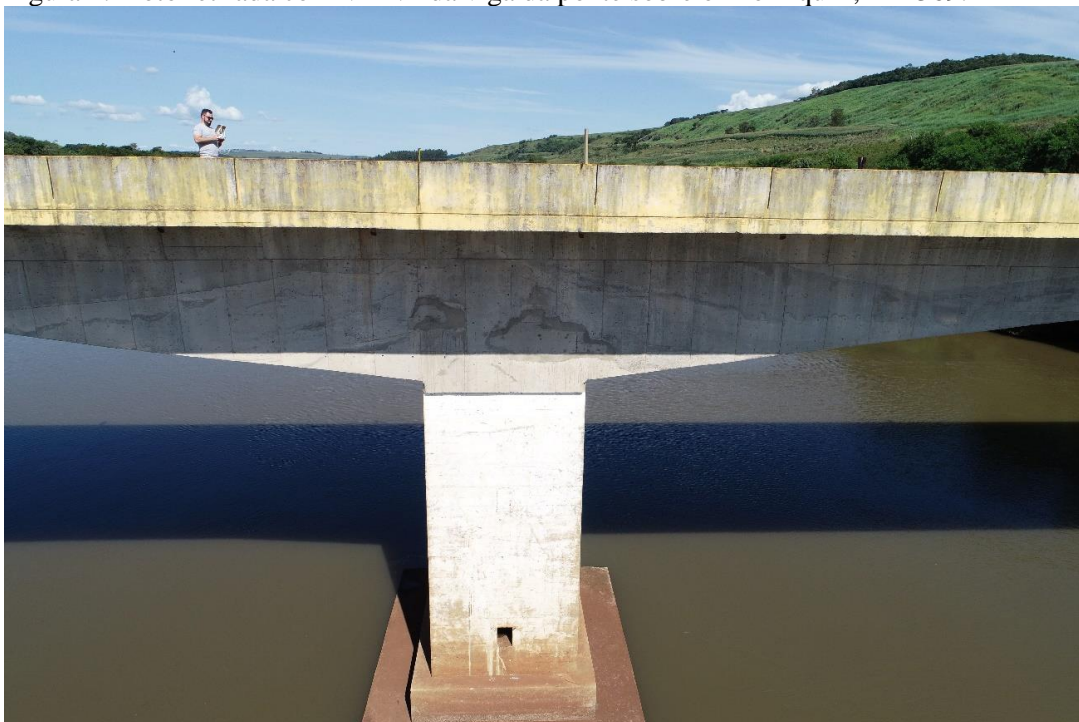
Foto retirada com VANT da viga da ponte sobre o Rio Piquiri, BR-369.
